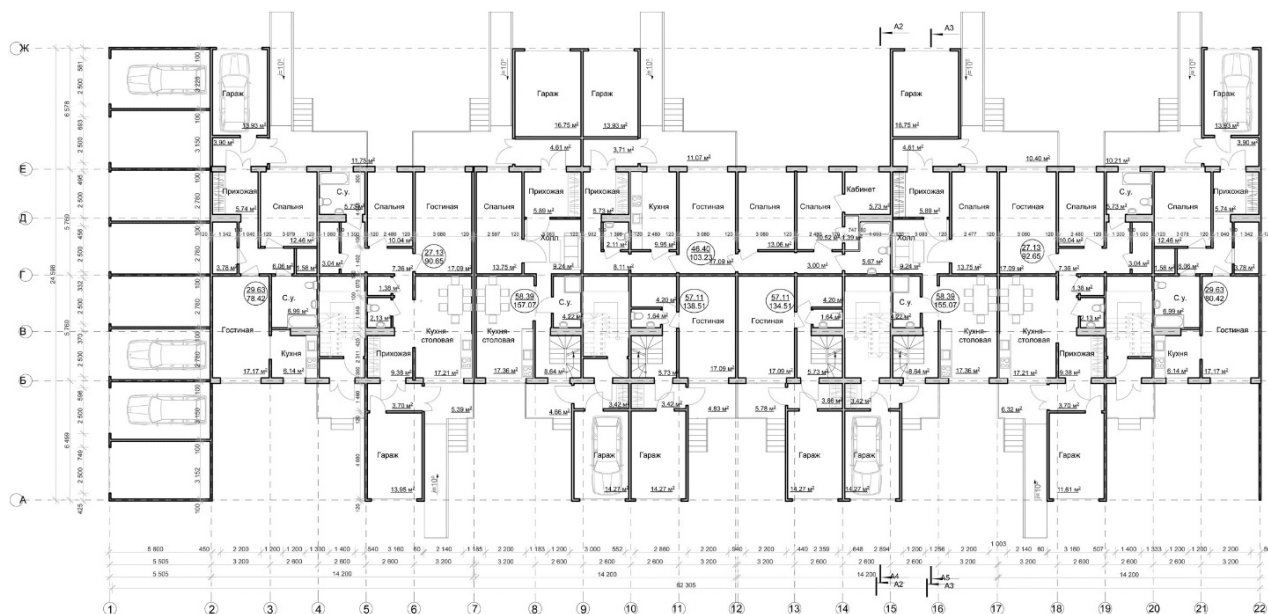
План первого этажа. Реконструкция с переходом от среднеэтажной к малоэтажной застройке
